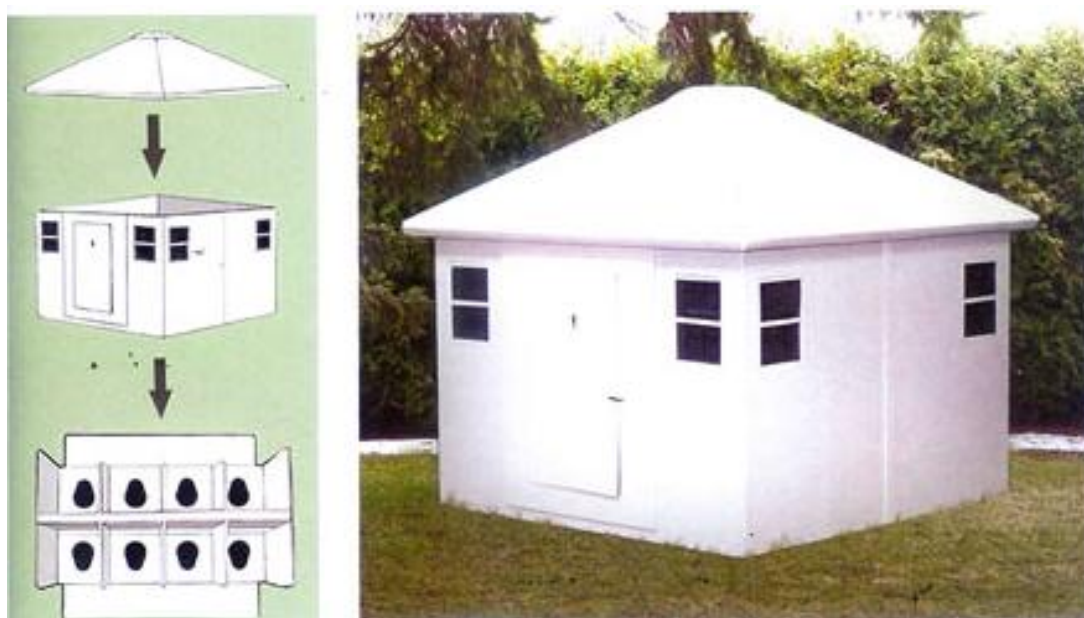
O Global Village Shelter é entregue em embalagens planas para o transporte e se desdobra-se para formar as paredes e o telhado. (Sinclair, 2006, p.77)
